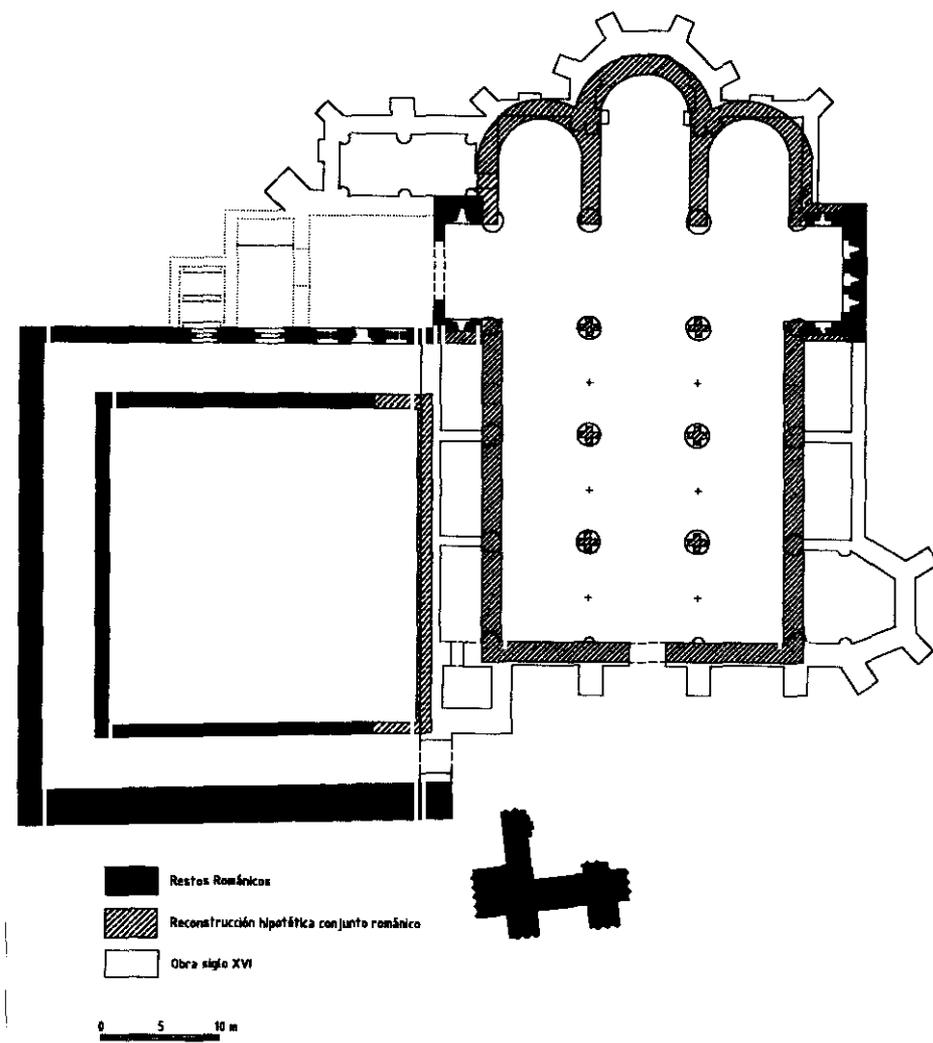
Hipótesis de reconstrucción I sobre planta actual.
